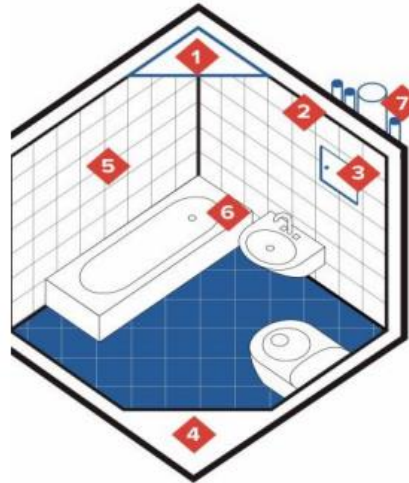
Конструкция сантехнического модуля (защитный слой и натяжной ПВХ-потолок – 1; металлический оцинкованный профиль – 2; ревизионный люк – 3; конструкция пола – 4; керамическая плитка – 5; сантехническое оборудование – 6; шахт пакет – 7) [45]
